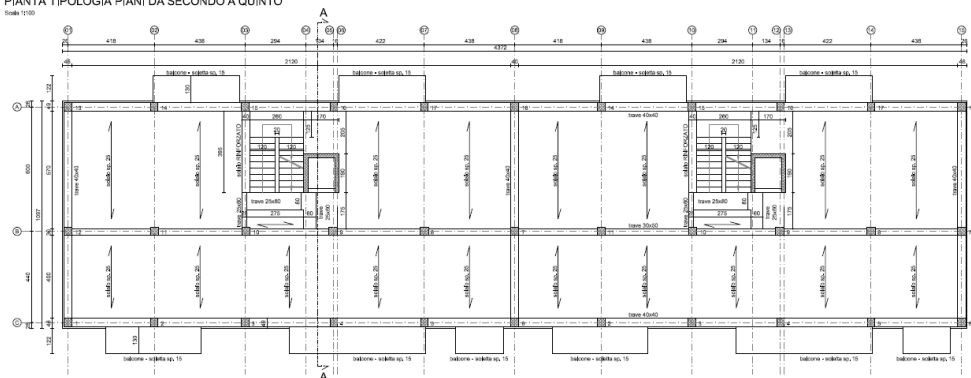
Strutture – pianta solai da piano secondo a quinto.
